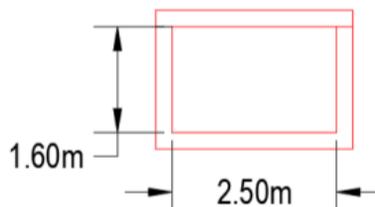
Sección propuesta para canal principal en los primeros 50 m.
